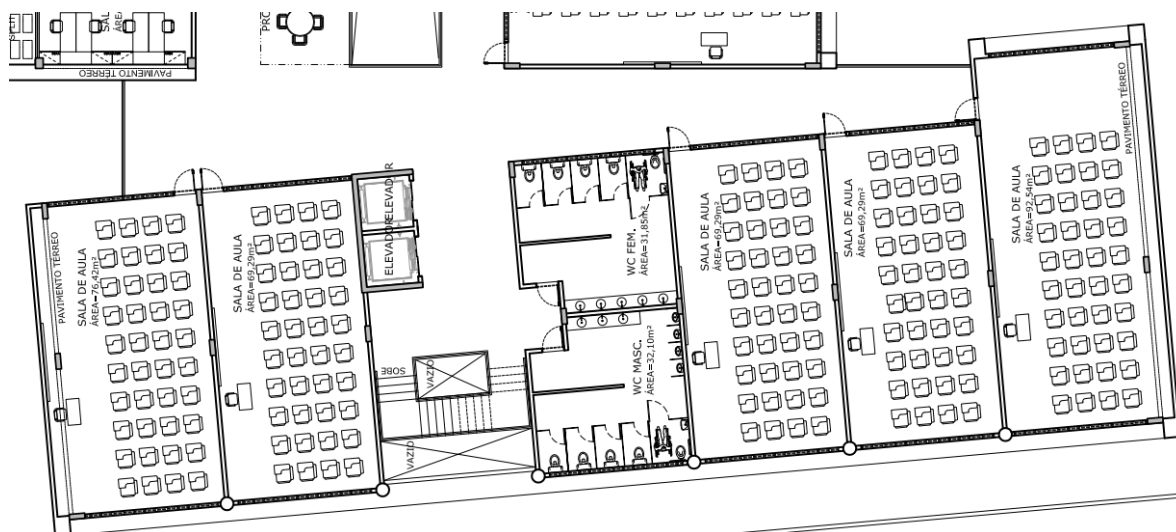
Salas de aula - 1º ao 4º Pavimento Bloco 03 - Fachada e Planta Baixa
